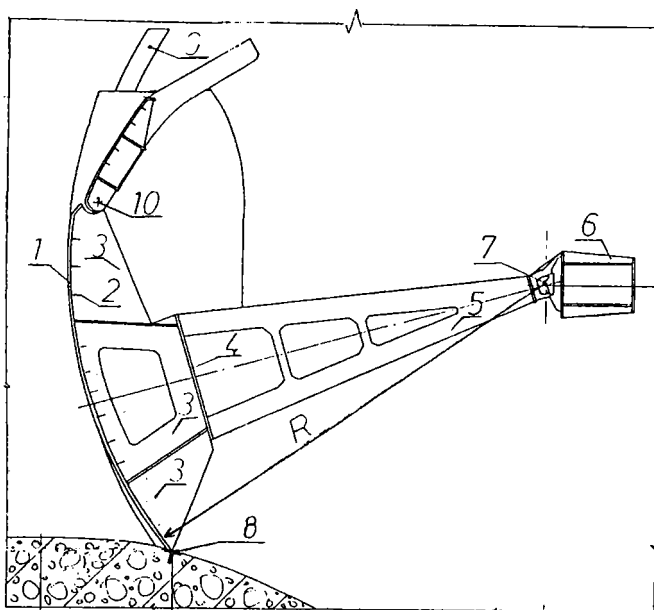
Stavilă segment cu clapetă . Secțiune verticală.
